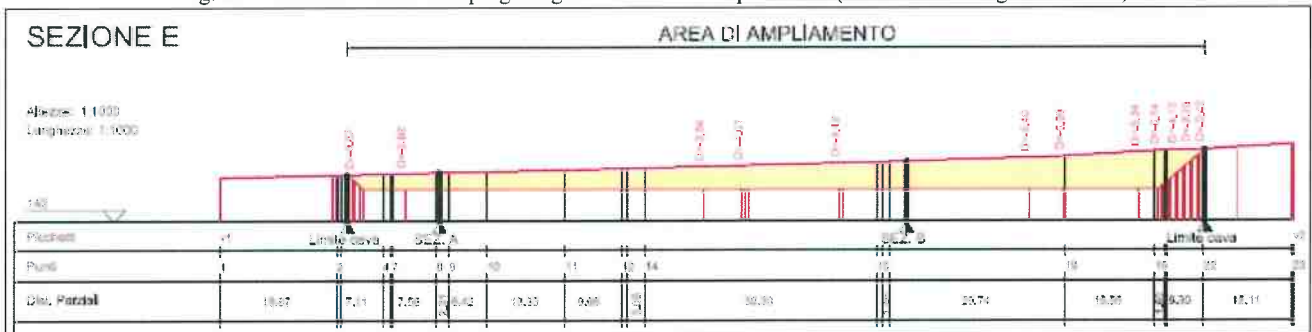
Sezione di scavo con progetto già autorizzato e ampliamento (dalla Tav. A allegata allo SPA)
